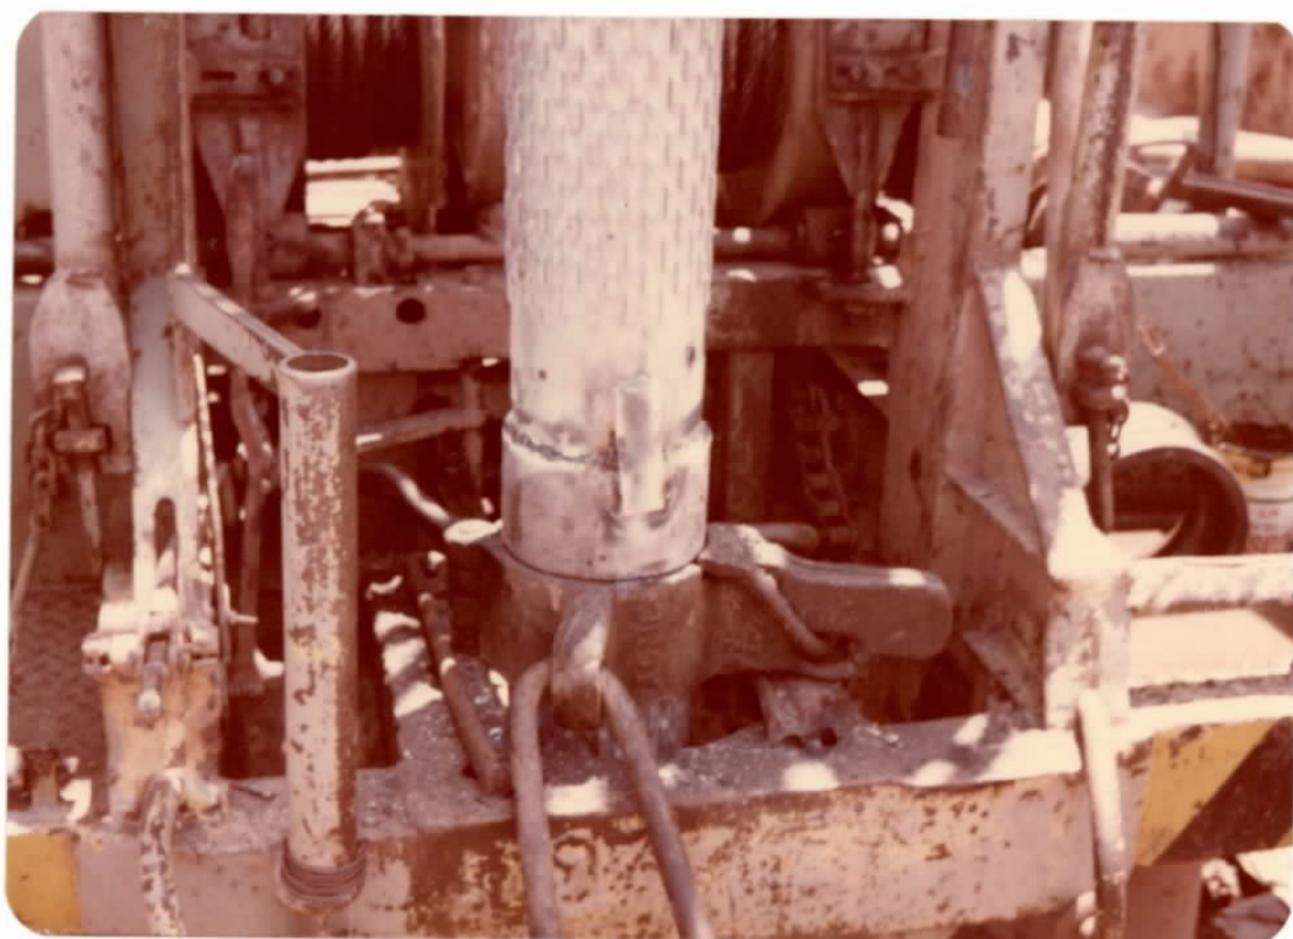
Detalhe da solda de emenda do filtro de um poço.
